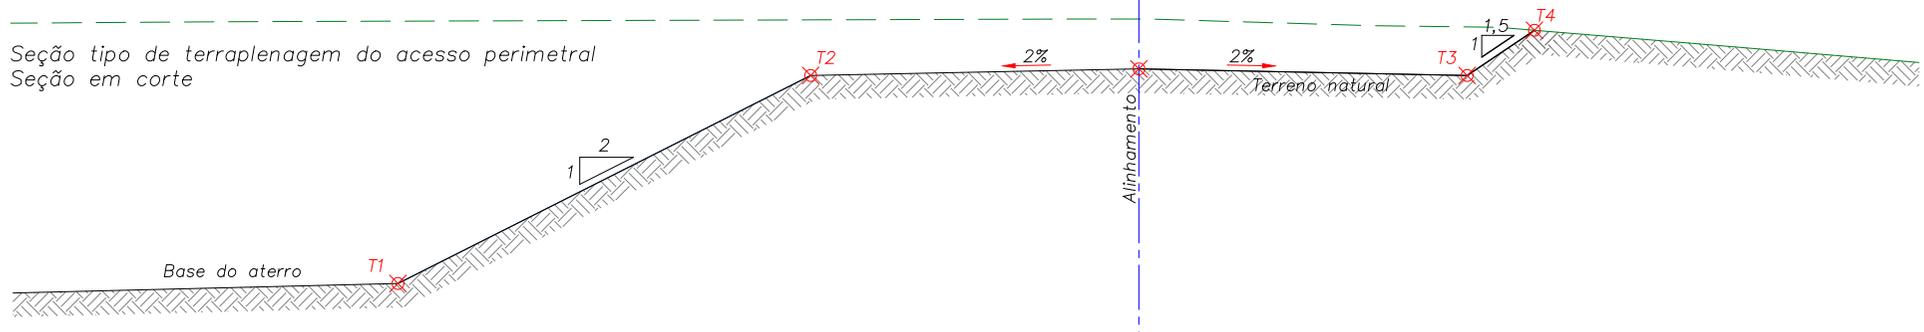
Seção transversal típica de implantação do acesso perimetral ao aterro.
